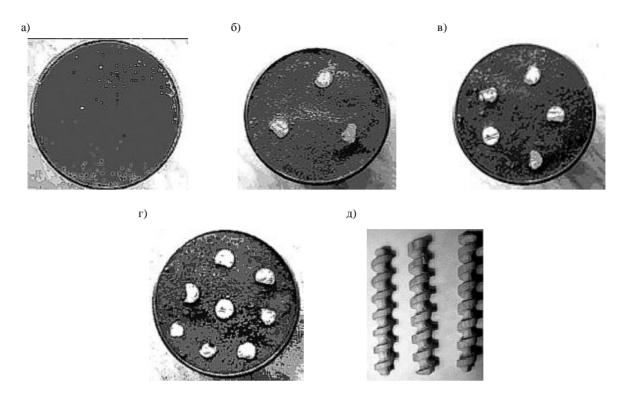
Образцы с рыхлым песком, армированным деревянными элементами-моделями. а) грунт без армирования; б) грунт армированный тремя армоэлементами-моделями; в) то же пятью; г) то же восемью
